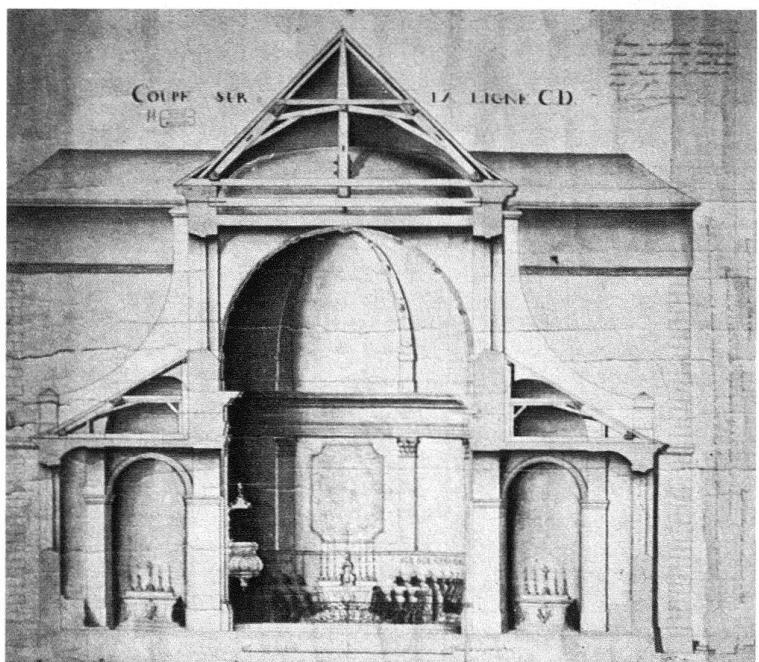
Pierre-François Paris, Coupe et profil, 1762, détail de la coupe transversale. Archives municipales, Delémont
